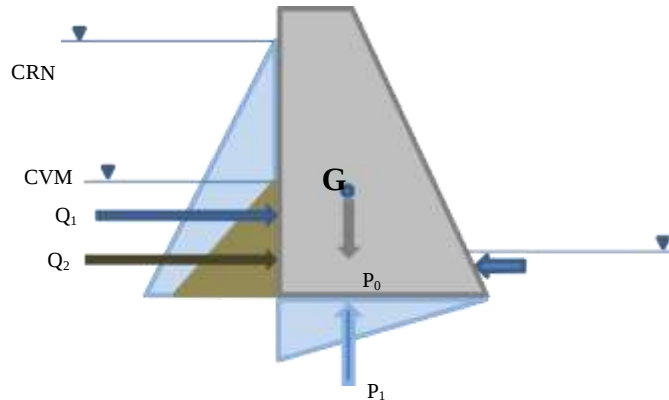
Forces agissantes sur la stabilité d'un barrage poids
